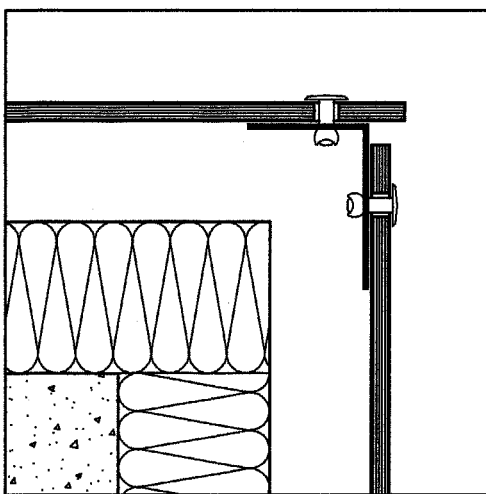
buitenhoek (horizontale doorsnede)
